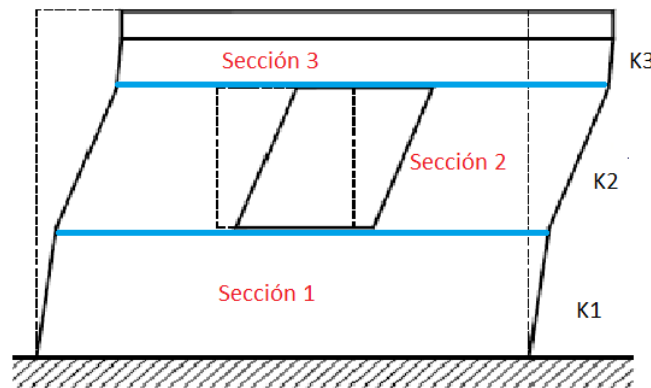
División de sub-segmentos de pared, de una pared con abertura de ventana
